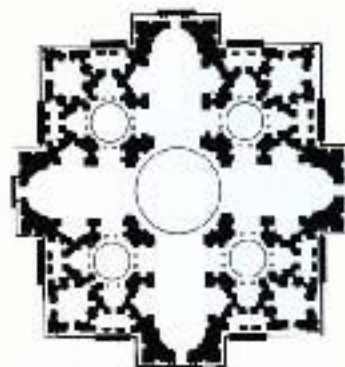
Pianta di San Pietro. Progetto di Bramante (da BERTELLI - BRIGANTI - GIULIANO 1991).
